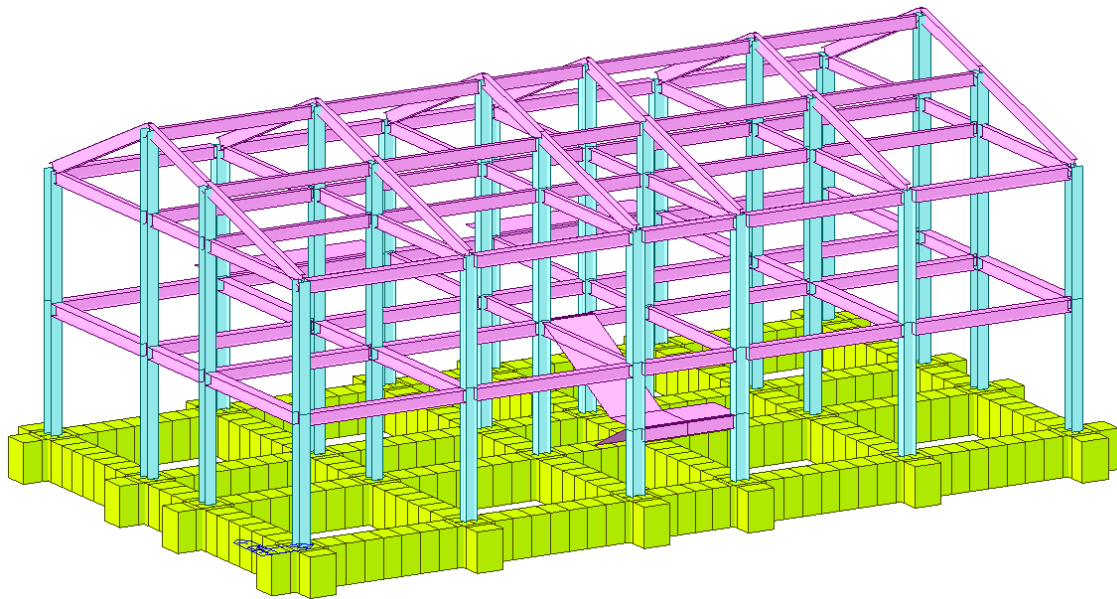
Modello FEM edificio a due piani in acciaio con trave rovescia - Vista assometrica 1.
